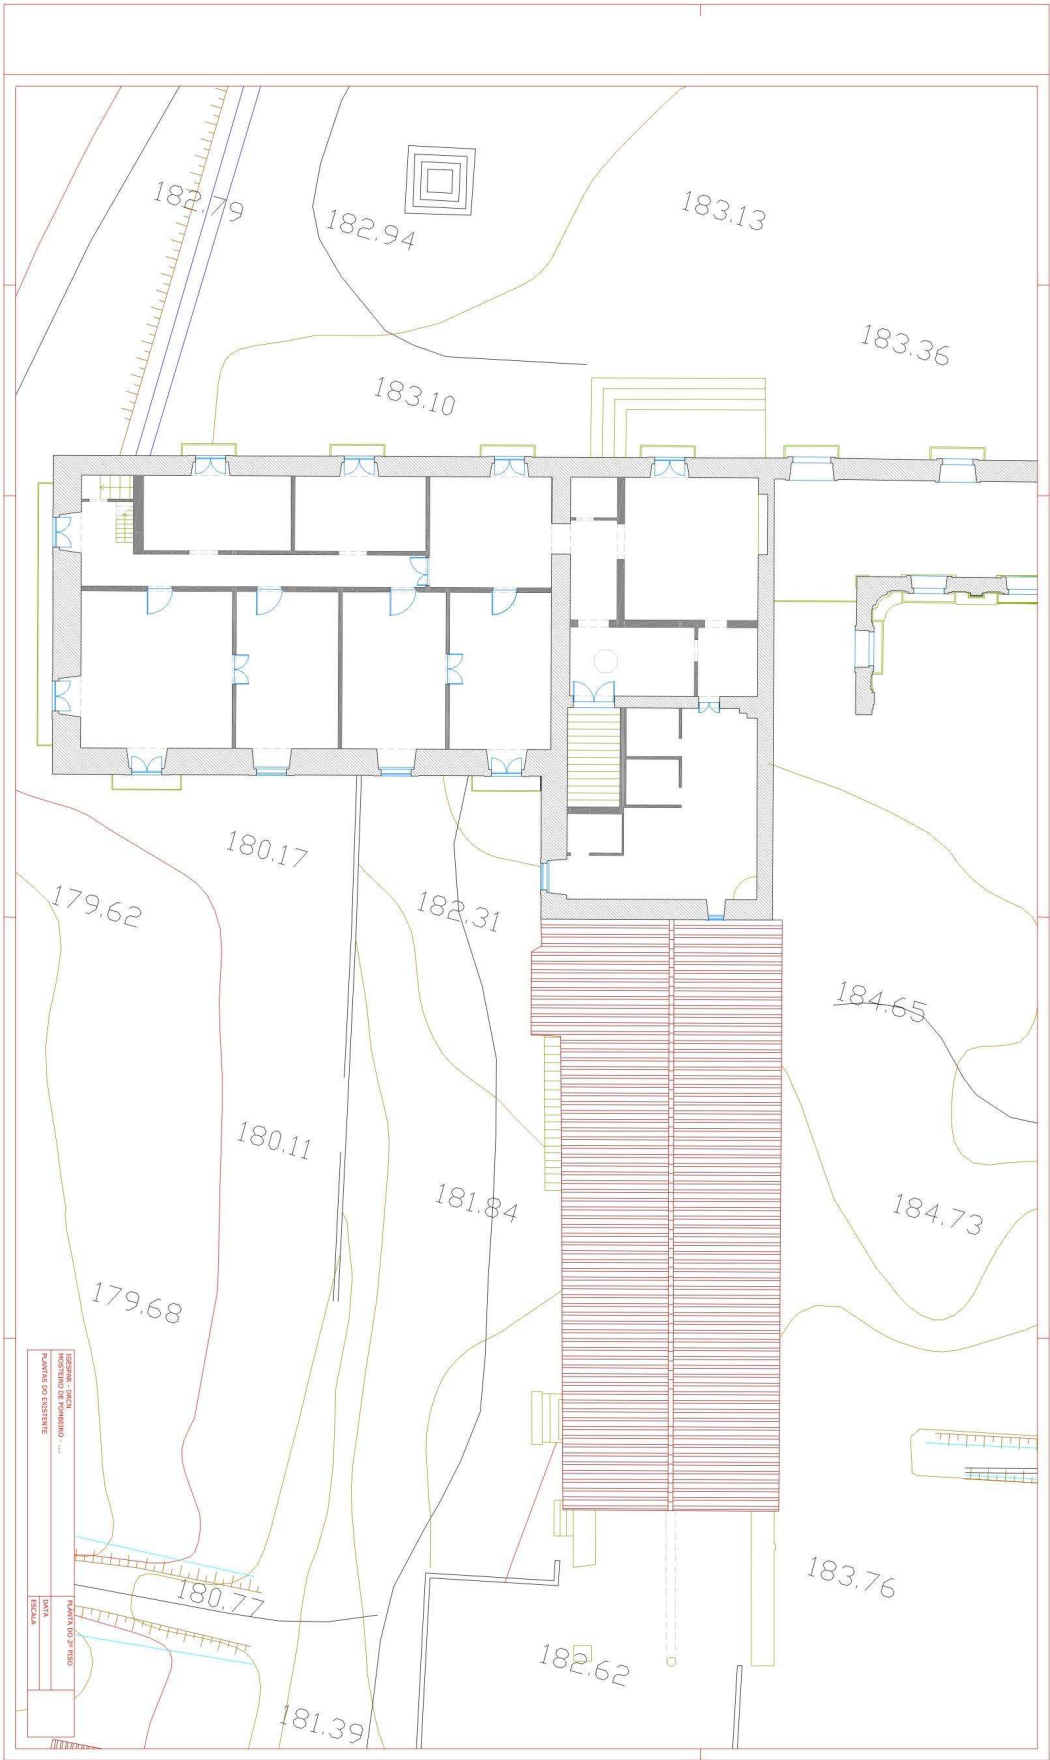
Planta do segundo piso do edificio da ala poente do Mosteiro de Santa Maria de Pombeiro (sem escala).
